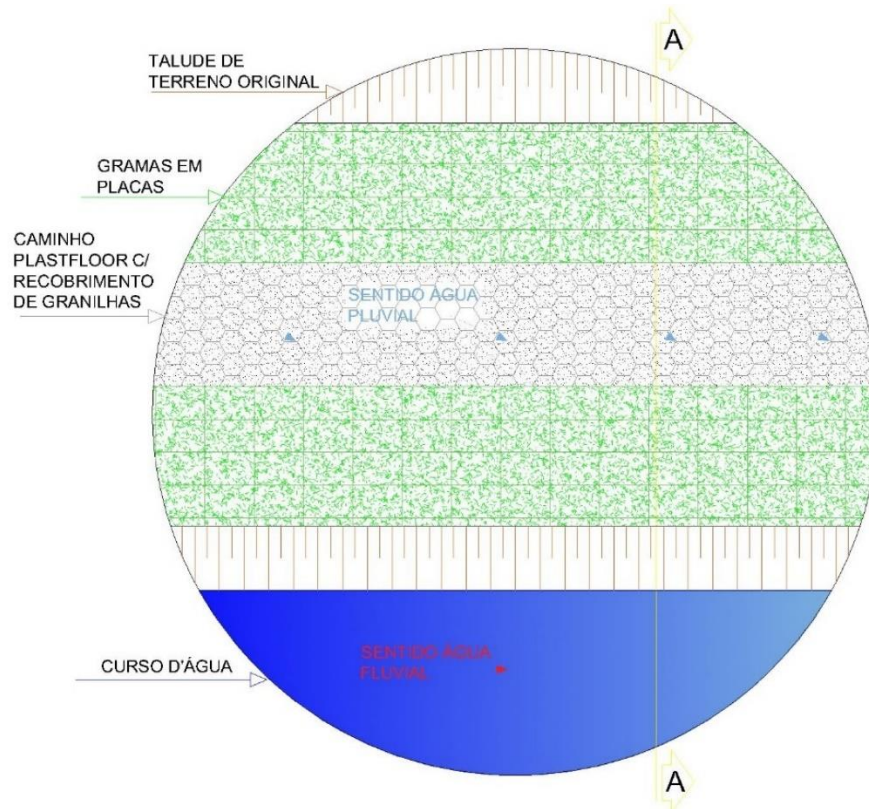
Croqui/planta de Caminho de Acesso com *Plastfloor
